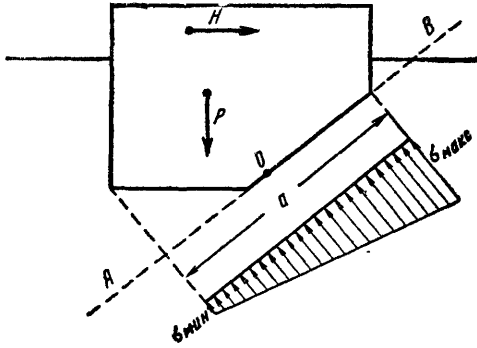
Схема к определению напряжений перед наклонной стенкой
